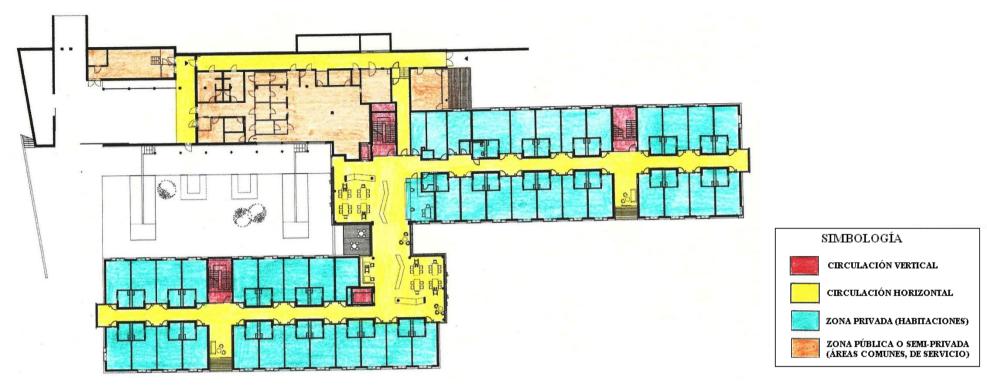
Planta de Primer piso del Asilo Gârtner + Neururer.
